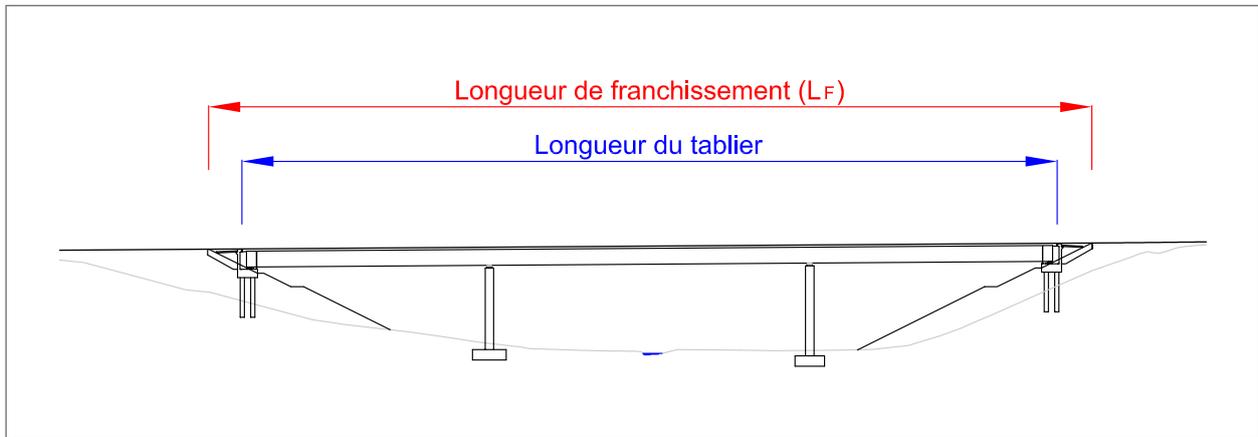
Longueur de franchissement  $L_f$  - Coupe longitudinale
